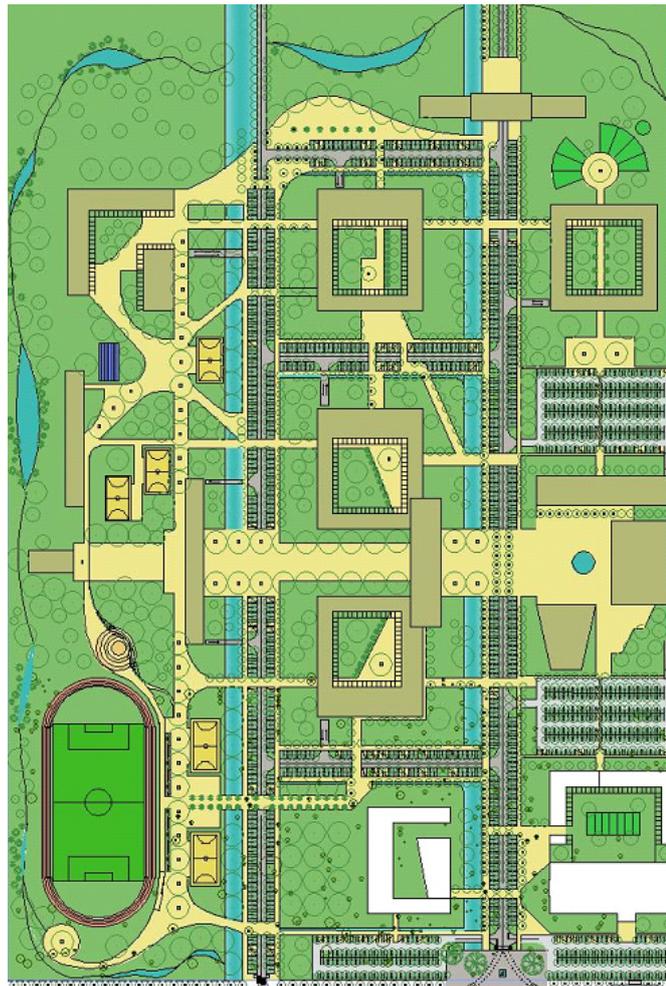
Campus de Planaltina da Universidade de Brasília. Planta geral. Calçadas para pedestres em amarelo; ecovalas em azul
